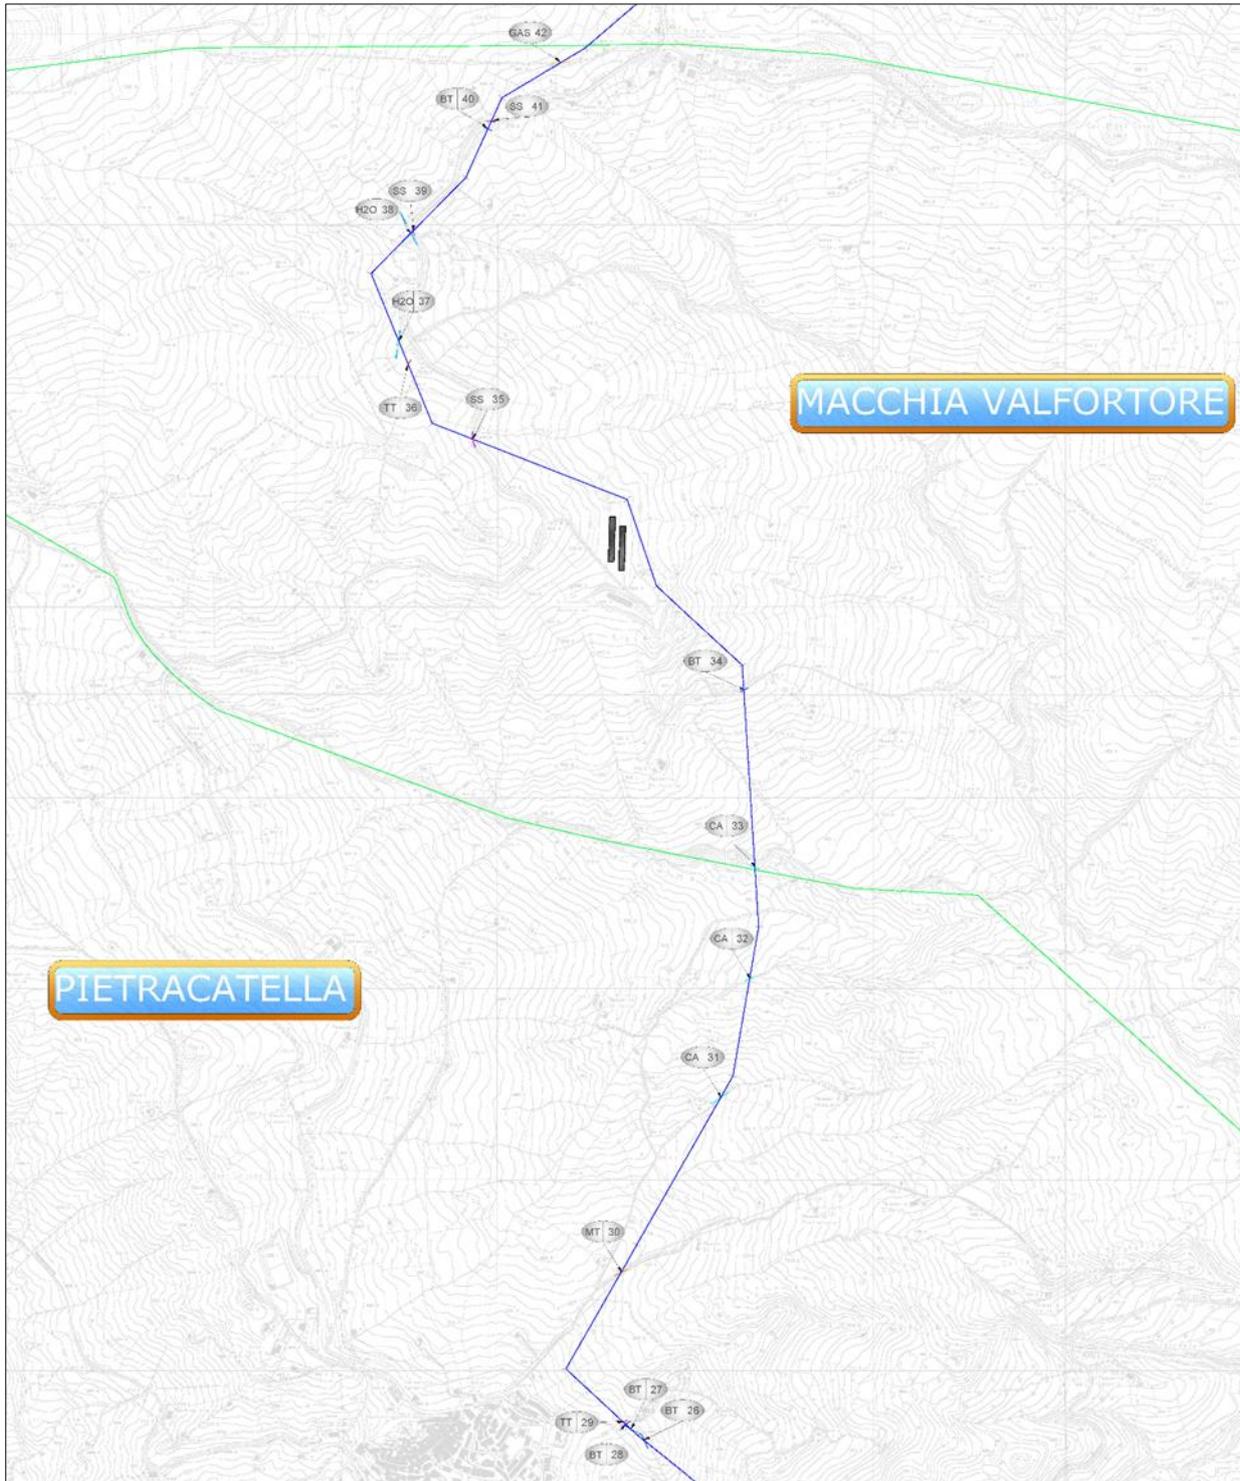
Stralcio planimetria tracciato elettrodotto su CTR (2/5)
